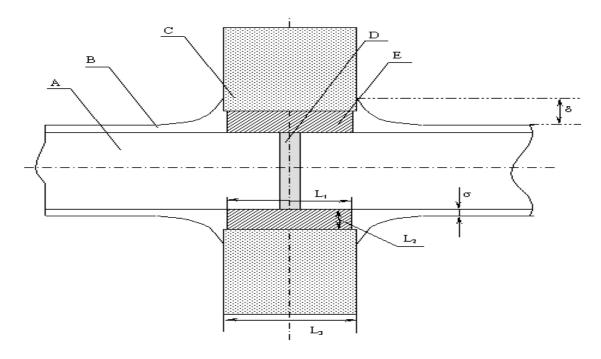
Разрез стенового прохода: A – металлический воздуховод; B – огнезащитное покрытие толщиной  $\sigma$  (нахлест на ограждающую конструкцию  $\delta$  должен быть не менее 50 мм); C – ограждающая конструкция толщиной  $L_3$ ; D – сварная рама (изготовленная из металлического уголка с размером полки, соответствующим размеру фланца), приваренная точечной сваркой внутри или снаружи воздуховода (если  $L_3 > 400$  мм, следует установить две рамы); E – цементно-песчаный раствор ( $L_2 = 30$  мм)
